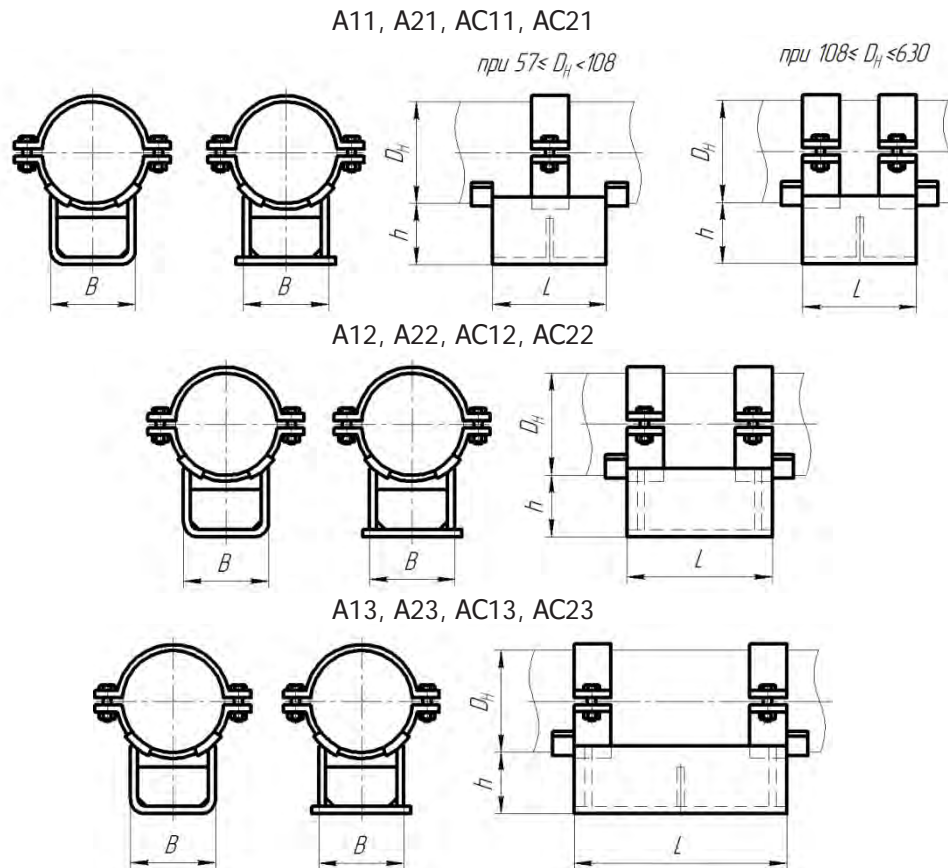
Опоры корпусные хомутовые (КХ)
